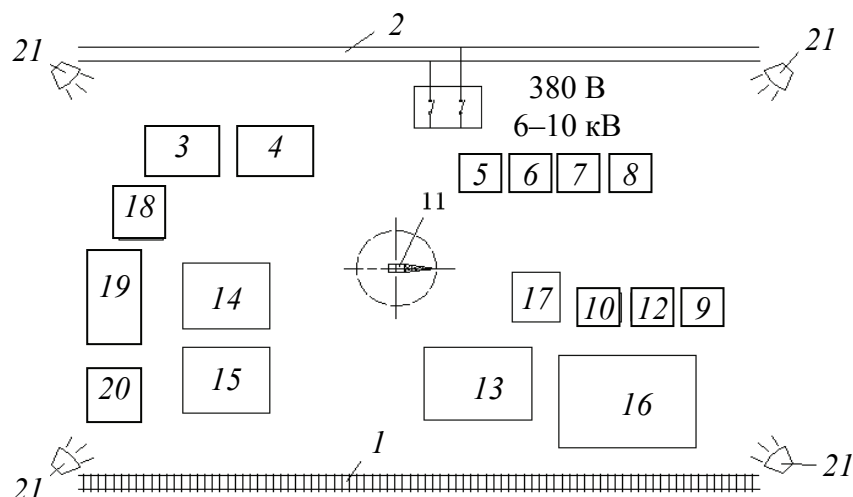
Устройство монтажной площадки: 1 – ж/д путь; 2 – электрическая сеть; 3 – управление руководителя монтажных работ; 4 – управление генерального подрядчика; 5 – РММ; 6 – инструментально-складские помещения; 7 – гардеробная и душевая; 8 – столовая; 9 – склад пиломатериалов; 10 – пожарный водоём; 11 – грузоподъемное оборудование; 12 – бытовые помещения; 13 – площадка для сборки машины; 14 – площадка для хранения электро-, гидро-, пневмооборудования; 15, 16, 17 – площадки для размещения деталей, узлов и механизмов, 18 – сварочный пост; 19 – компрессорная станция; 20 – склад для вспомогательного грузоподъемного и такелажного оборудования; 21 – осветительные средства
